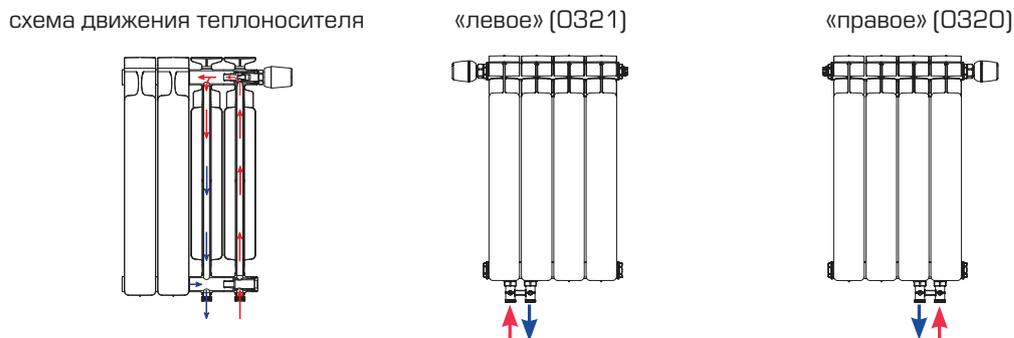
Возможные схемы нижнего подключения (0320/0321) радиаторов STOUT Space Ventil к трубопроводам системы отопления
